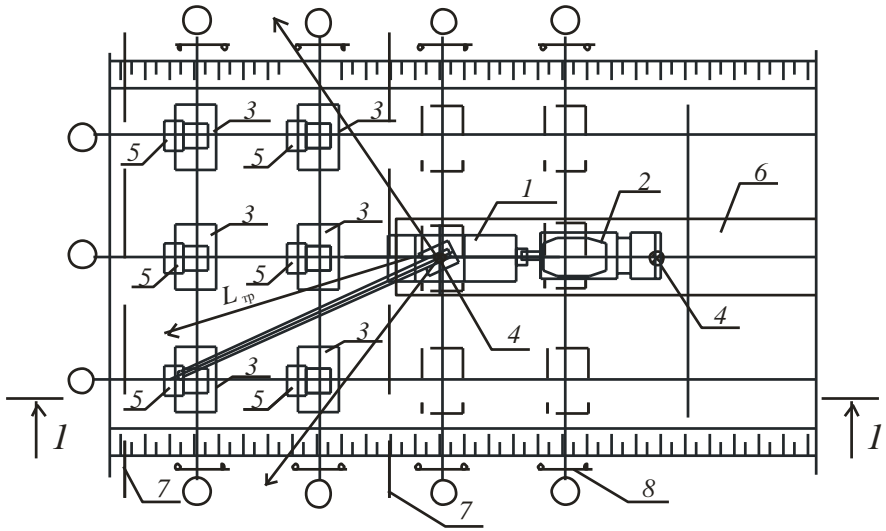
Технологическая схема бетонирования фундаментов при помощи автобетононасоса:
